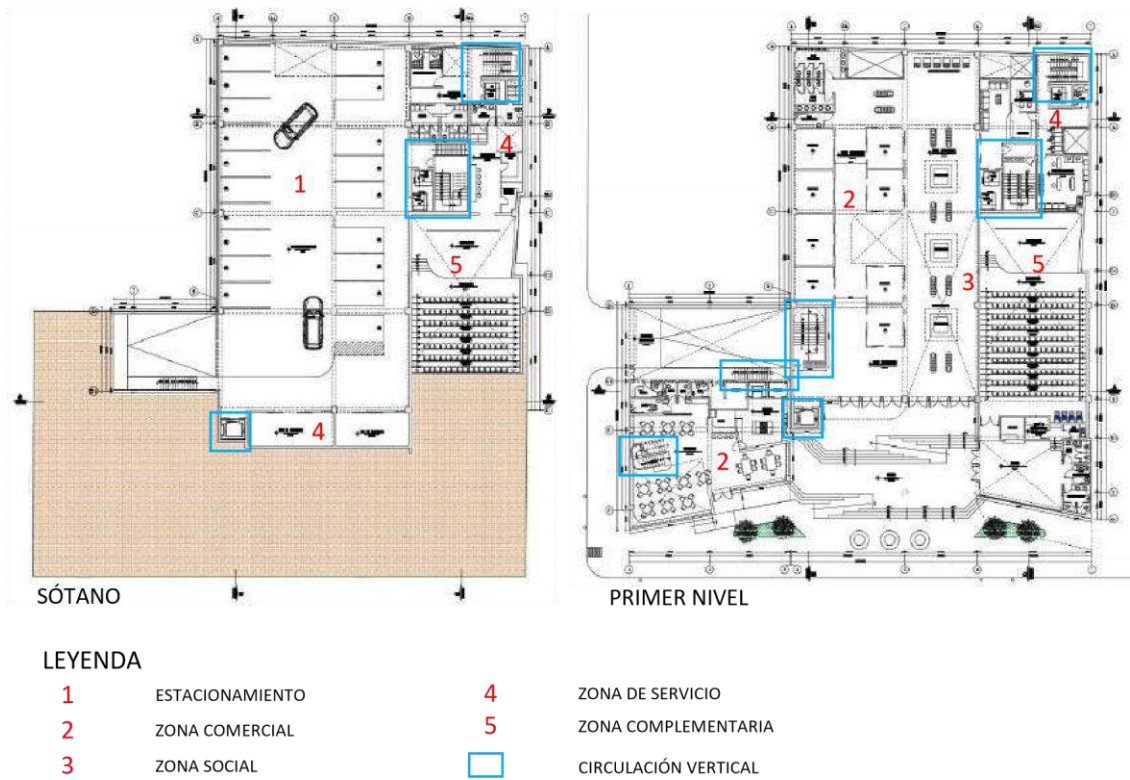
Planos del sótano y primer nivel del Centro Empresarial. Fuente: Elaboración propia.
